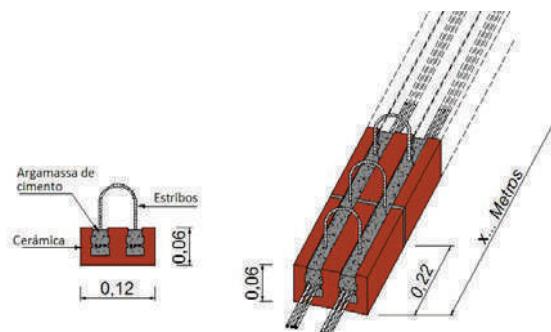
Tijolo tipo Stalton para fazer vigotas. As armaduras são levemente pré-tensadas. (*-5).
